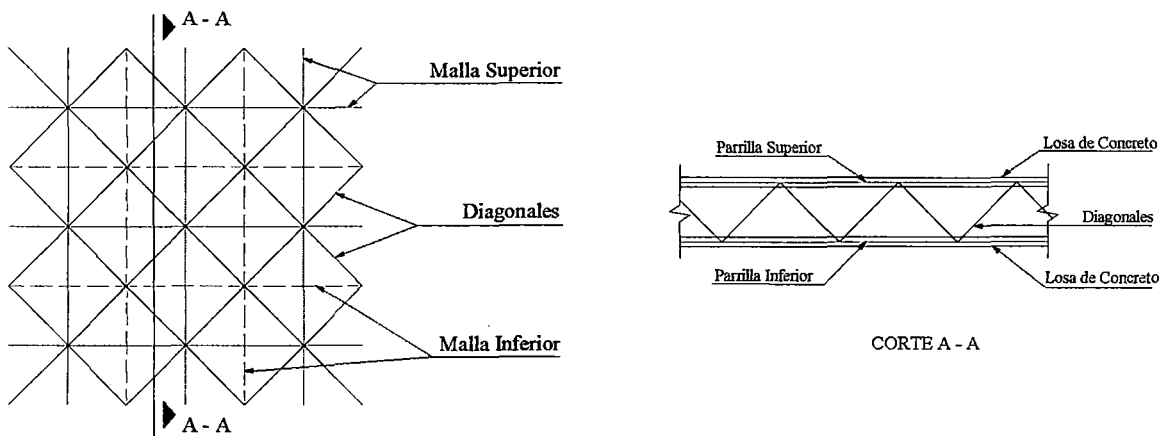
Detalle Típico de Planta de una Tridilosa
